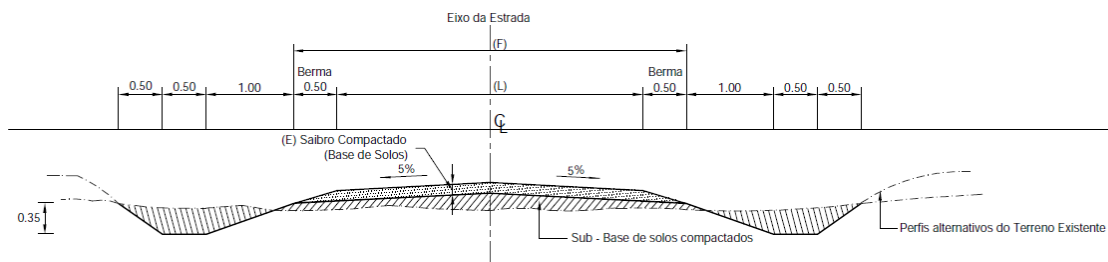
Perfil transversal tipo em terreno plano (Fonte: [2])
